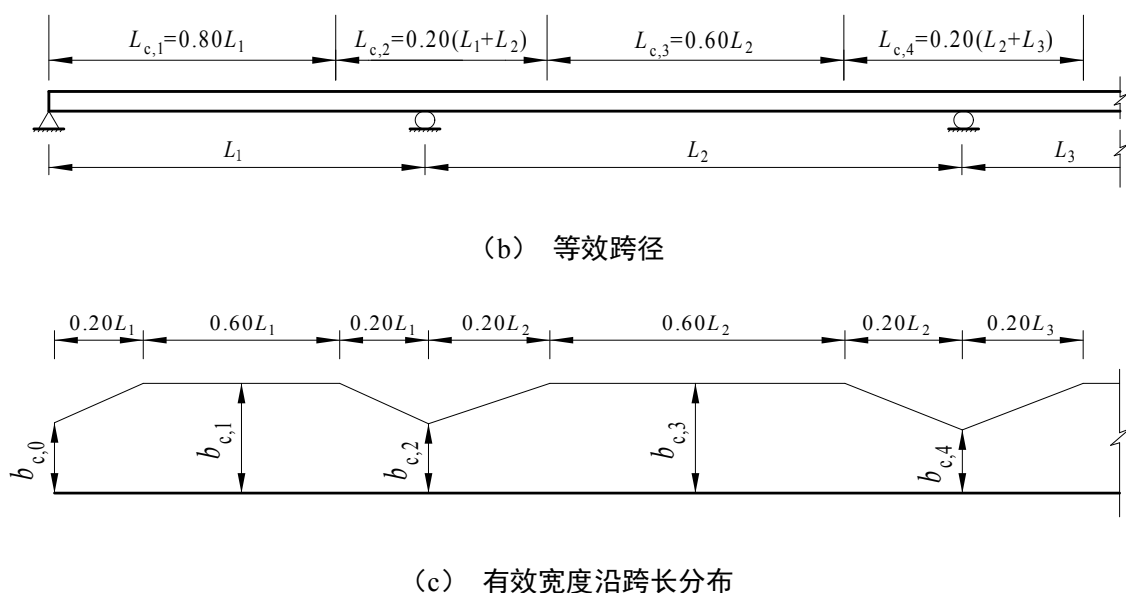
混凝土桥面板等效跨径及有效宽度示意图
